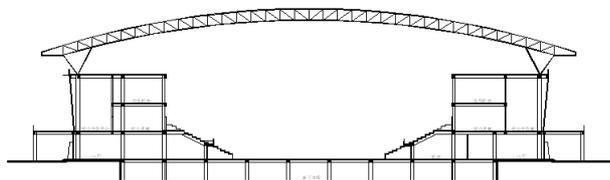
混凝土框架看台+大跨钢屋盖体育馆剖面图
